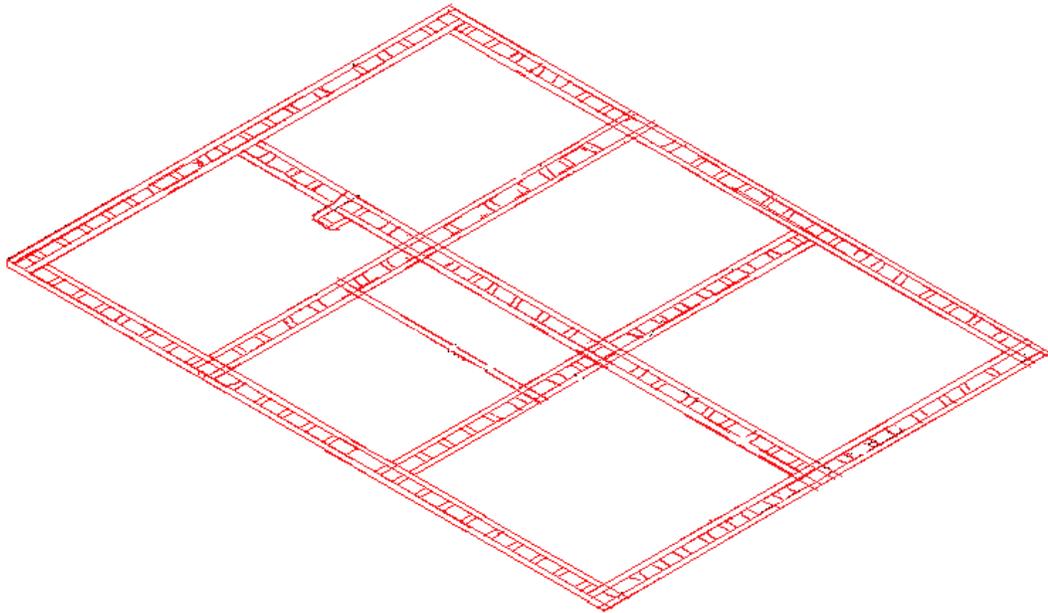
Viga collar. Fuente: Elaboración propia.
